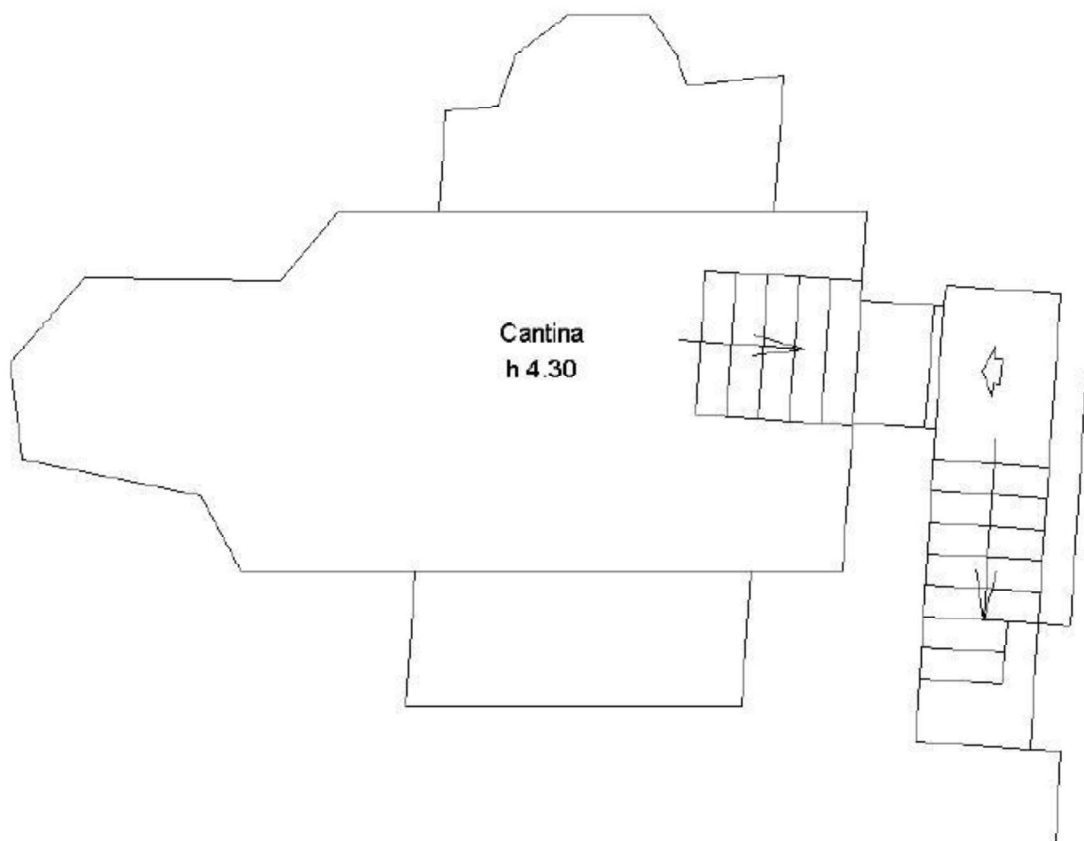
Planimetria Catastale Deposito Piano Interrato.
